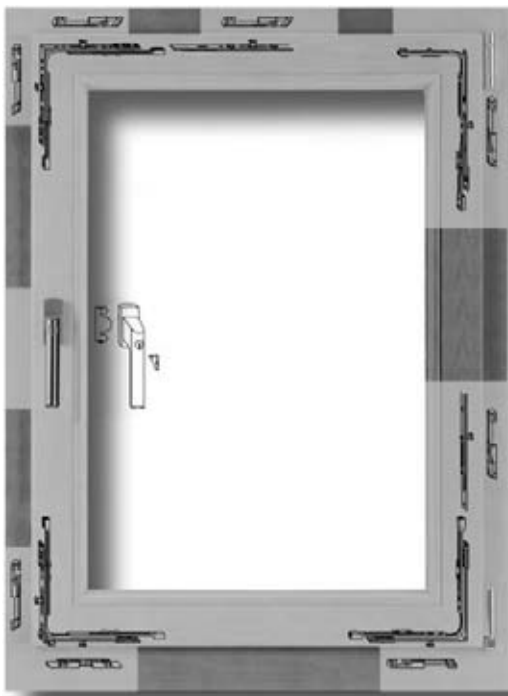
Einbruchhemmendes Fenster mit Pilzkopfschrauben-Beschlägen
